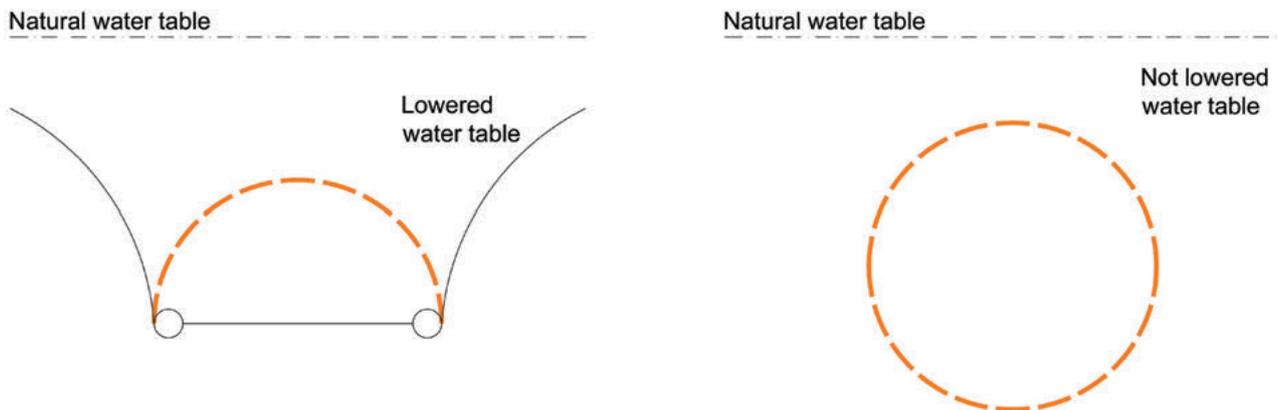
Diagramma concettuale di una galleria drenante (sinistra) e di una con impermeabilizzazione *full-round* (destra).
